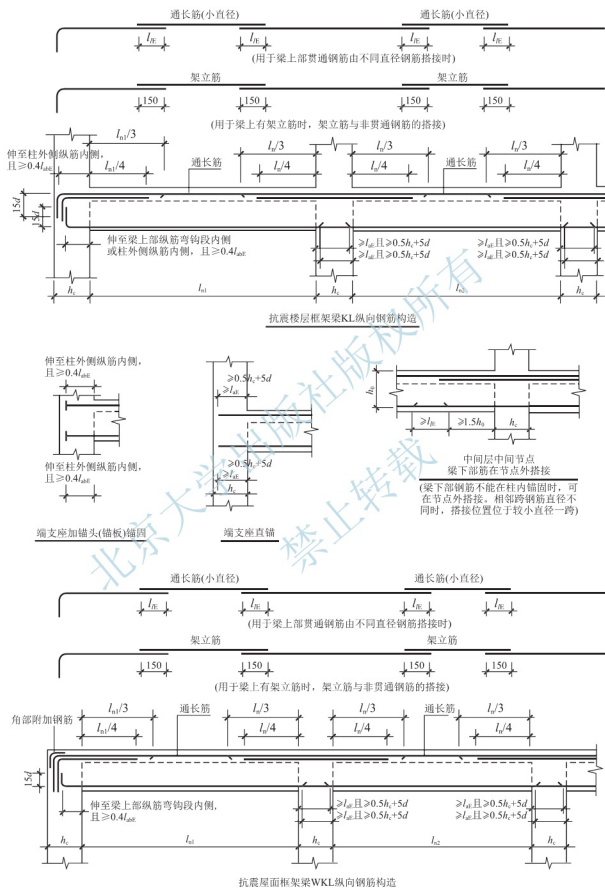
抗震框架梁 KL 和抗震屋面框架梁 WKL 纵向钢筋构造
